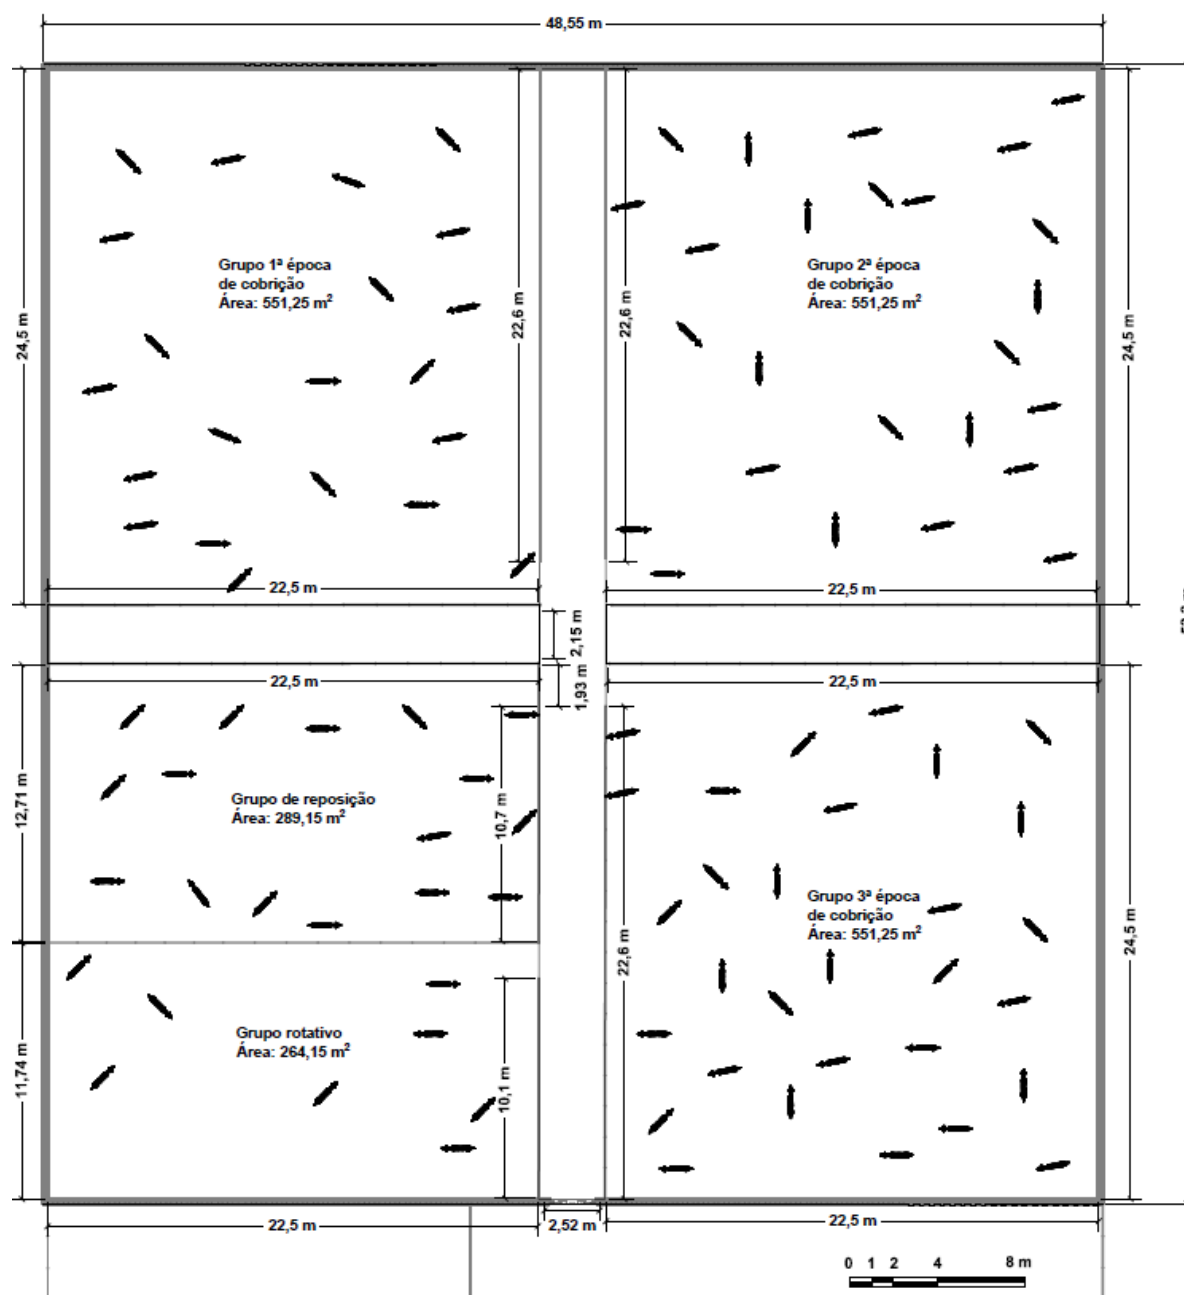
Planta do alojamento das cabras produtoras e cabritas de substituição.
